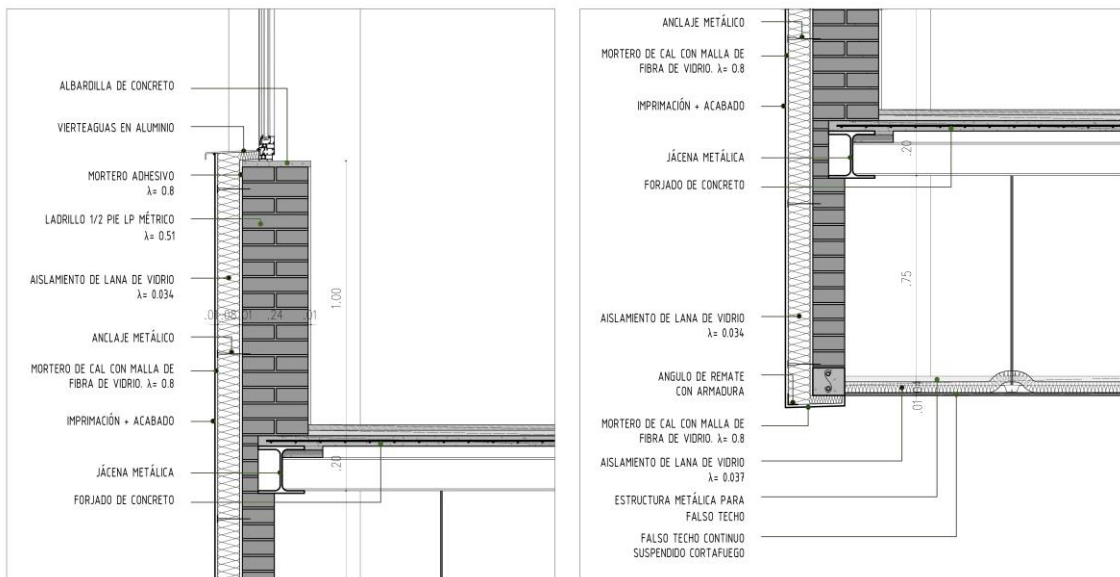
Detalle de corte por fachada / Detalle de encuentro de fachada con solera en contacto con el exterior.
